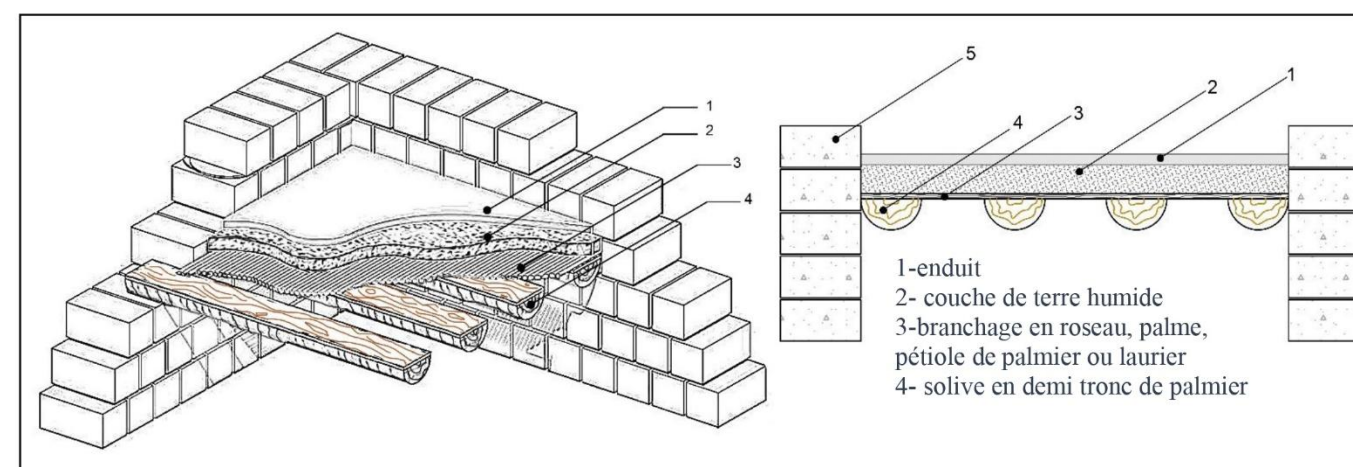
Axonométrie et coupe verticale d'un plancher traditionnel placé directement sur le mur, constitué de solive de 1/2 tronc de palmier
